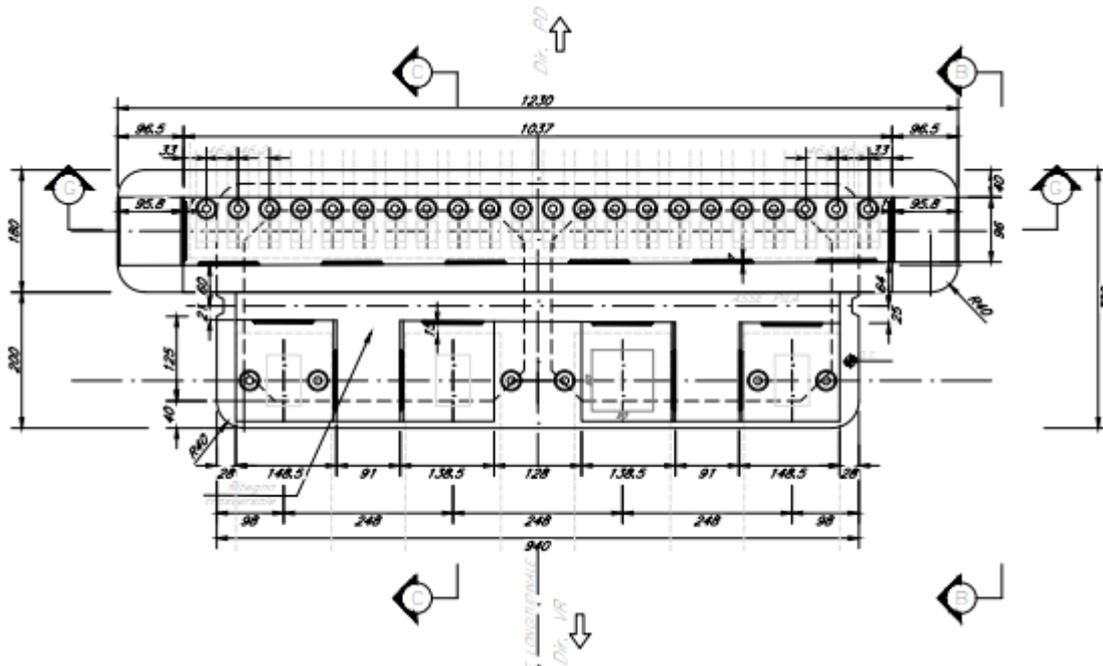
Sezione trasversale pila (lato Travi Incorporate)
